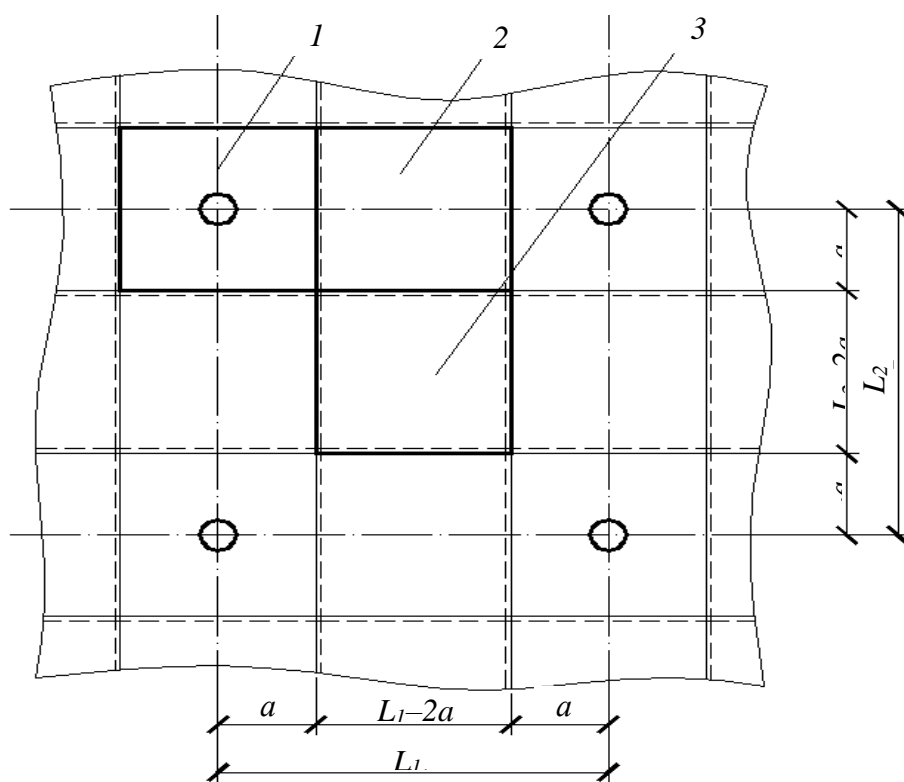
Фрагмент розрахункової схеми сталезалізобетонного безбалкового перекриття системи А:
